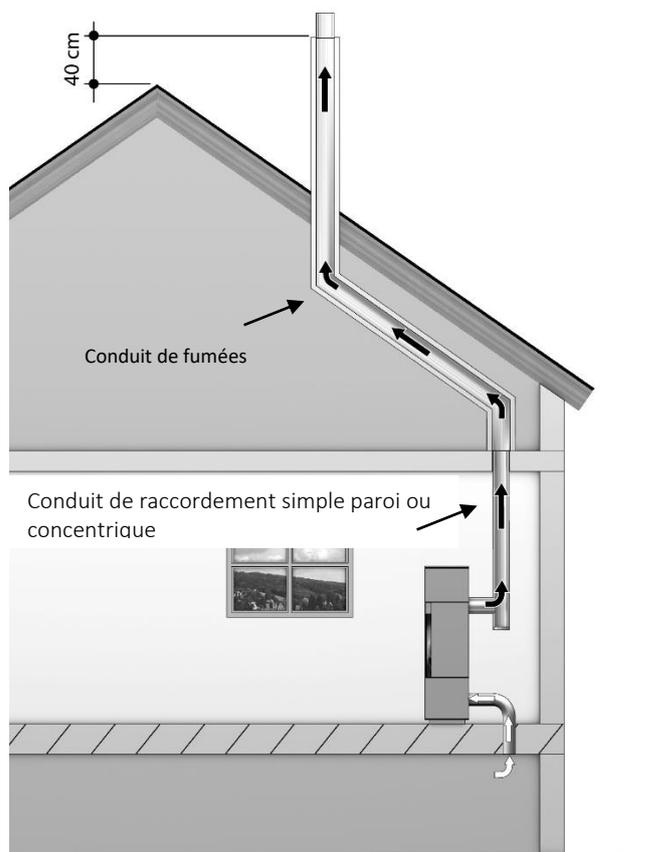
Installation étanche Zone 1; Vide sanitaire ou cave ventillé
